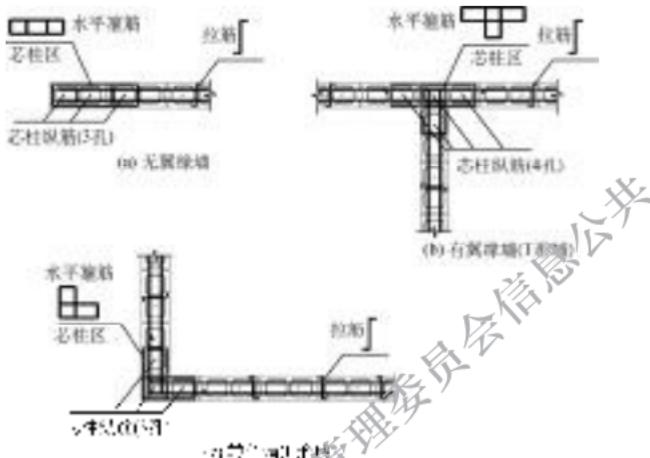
配筋小砌块砌体抗震墙的构造边缘构件
